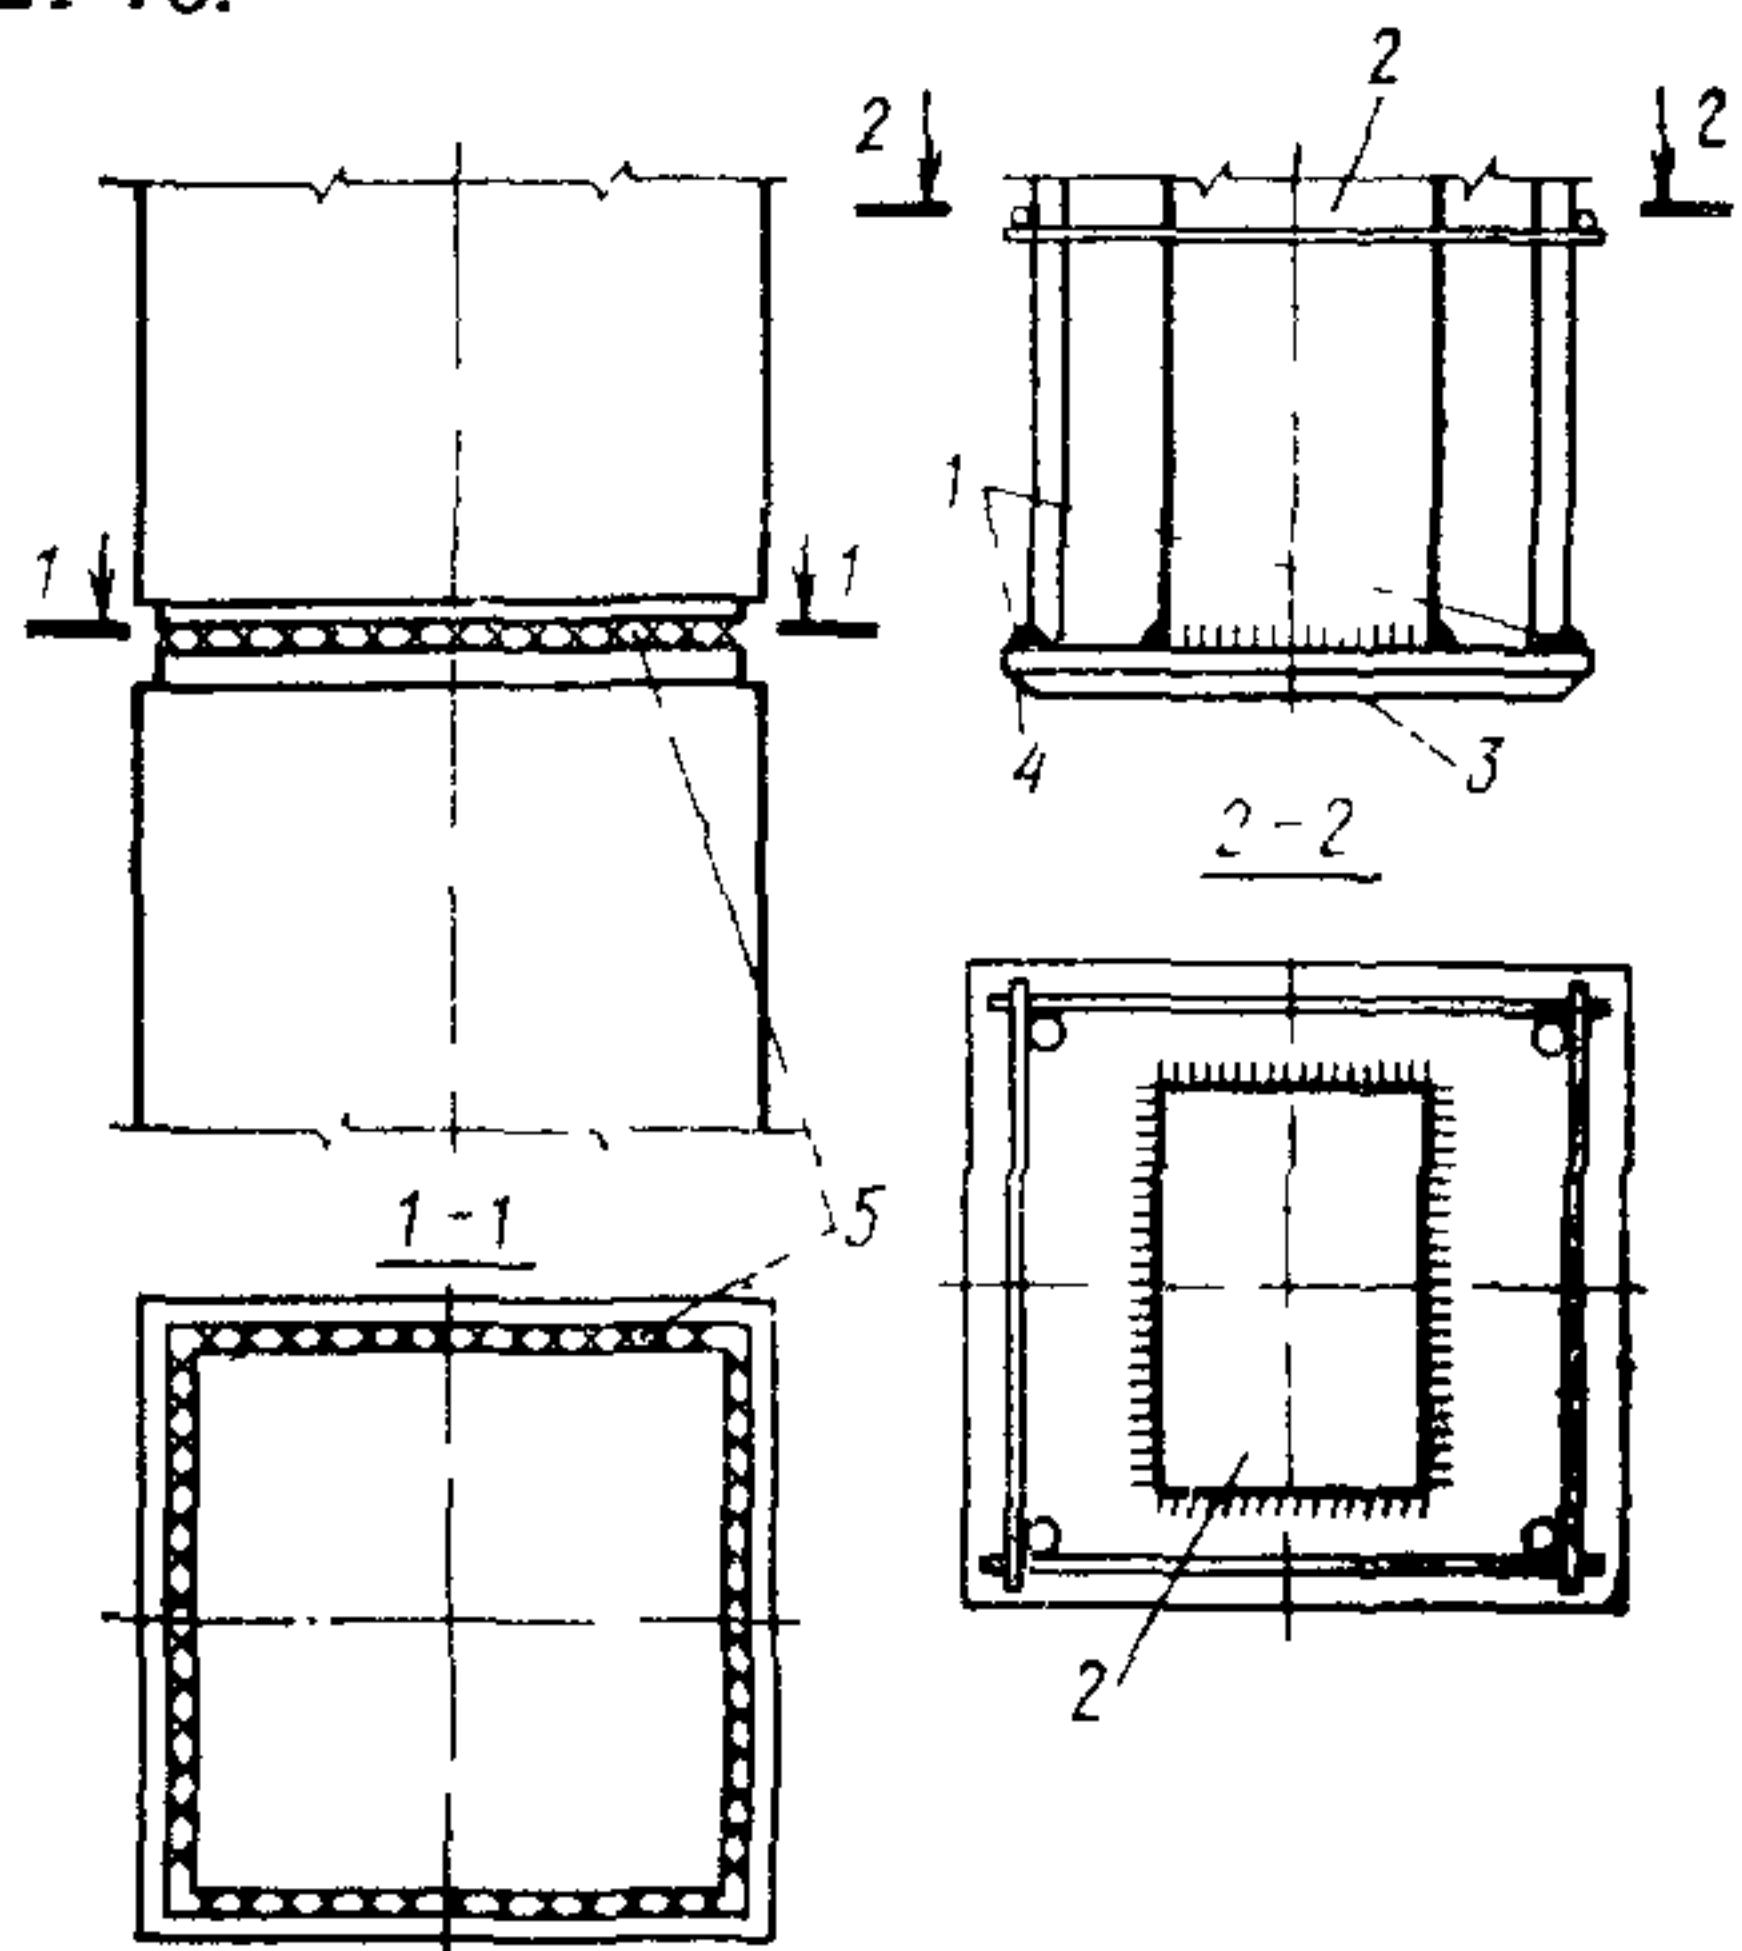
Стык железобетонных колонн с жесткой арматурой типа сердечник
